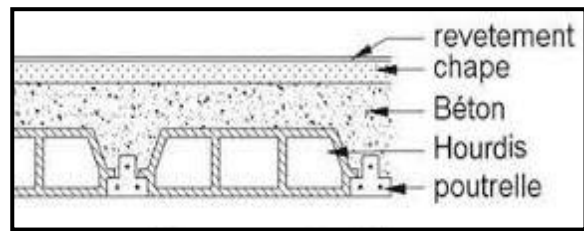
(VI.7) : coupe d'une dalle en corps creux
